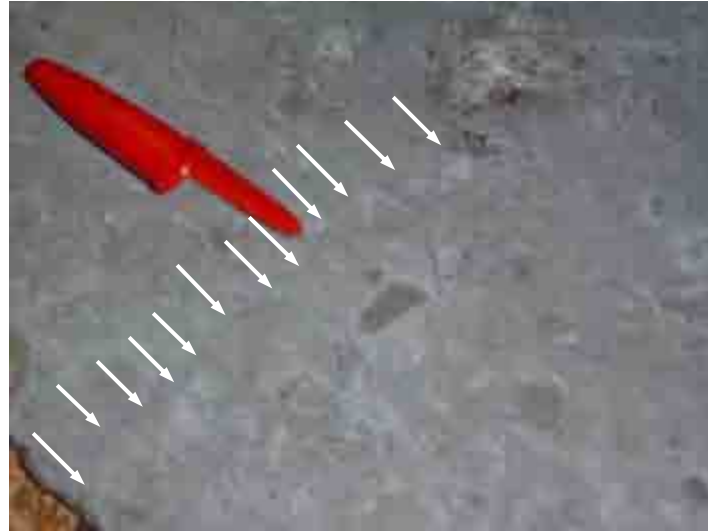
1ª fissura (0,1mm) em uma das placas de CAD com Borracha
